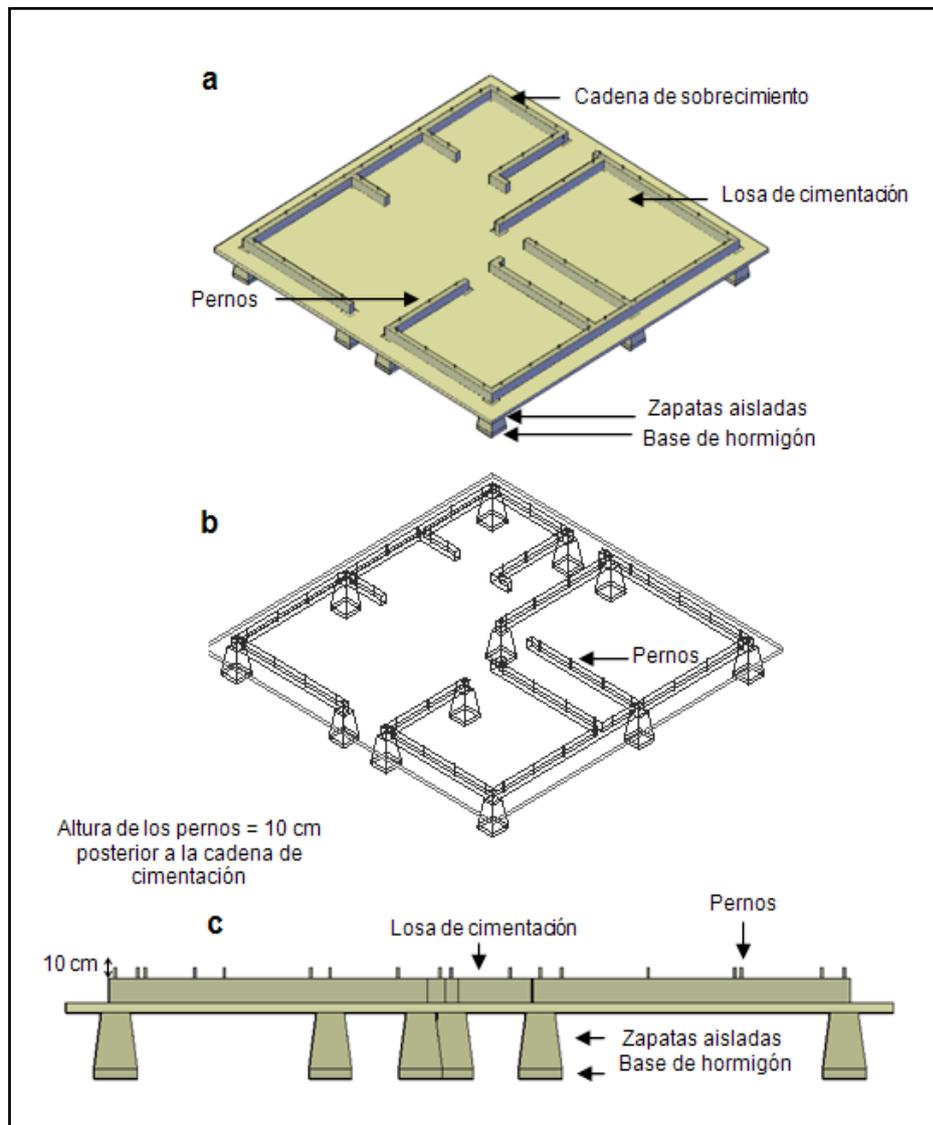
a) Zapatas, cadena y losa de cimentación; b) Ubicación las zapatas y los pernos de anclaje incrustados en la cadena de cimentación; c) Vista frontal de la cimentación con los pernos de anclaje.
